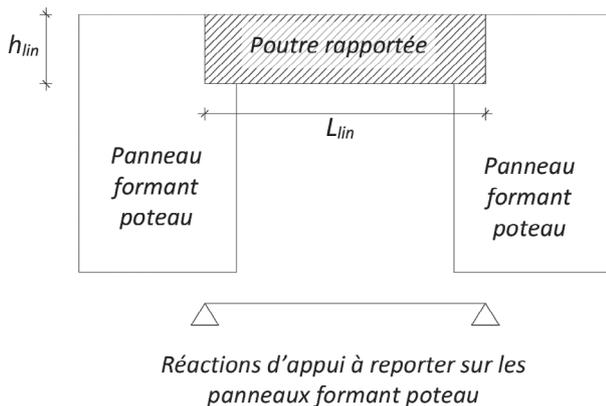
Linteau constitué de poutre rapportée – Modélisation
